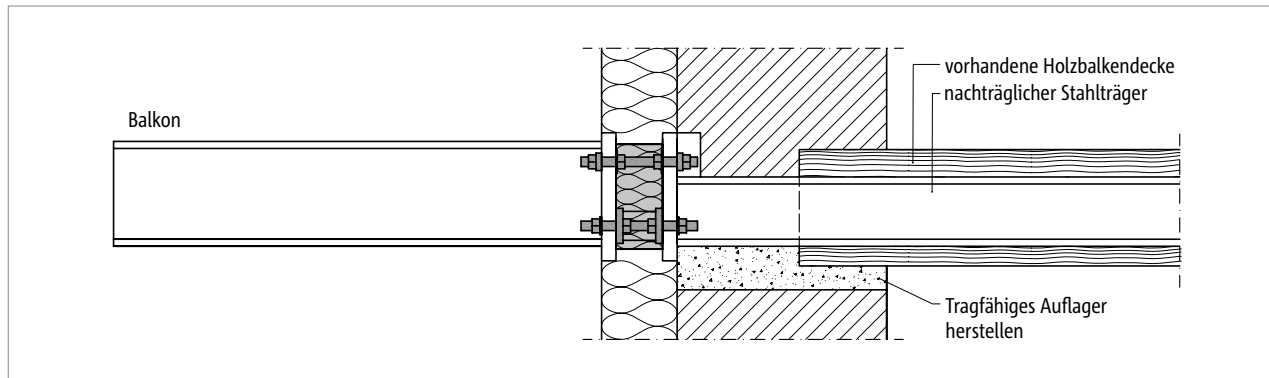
Schöck Isokorb® T Typ S: Stahlbalkon frei auskragend; angeschlossen an Holzbalkendecke
